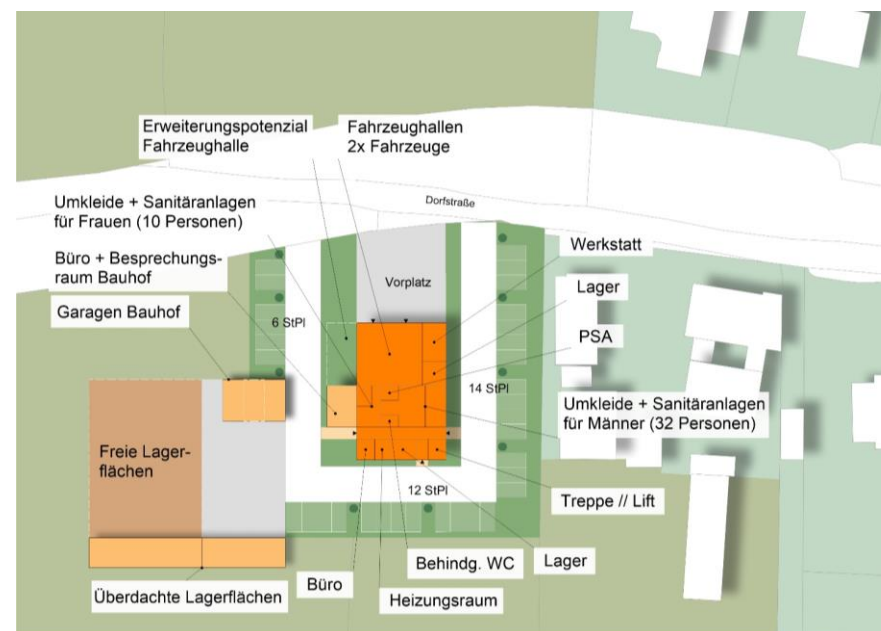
Städtebaulicher Testentwurf der Erdgeschossnutzungen des Feuerwehrgerätehauses samt Bauhof in Richtung Osdorf (CIMA 2022)
